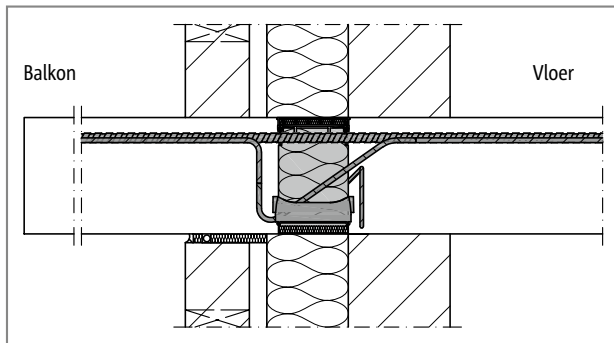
Schöck Isokorb® CXT type K-E: balkon bij achteruitspringende gevel
